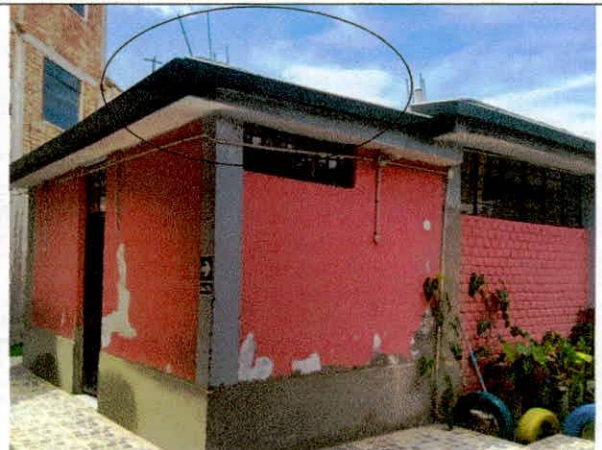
deterioro en muro de albañilería, presencia de sulfatos y desprendimiento de pintura en dicho muro, MODULO N° 01
